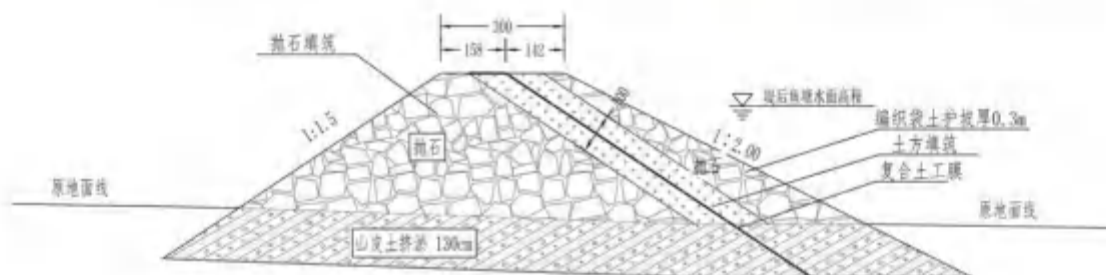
堤后方坡脚临时围堰典型断面图（单位：cm）
